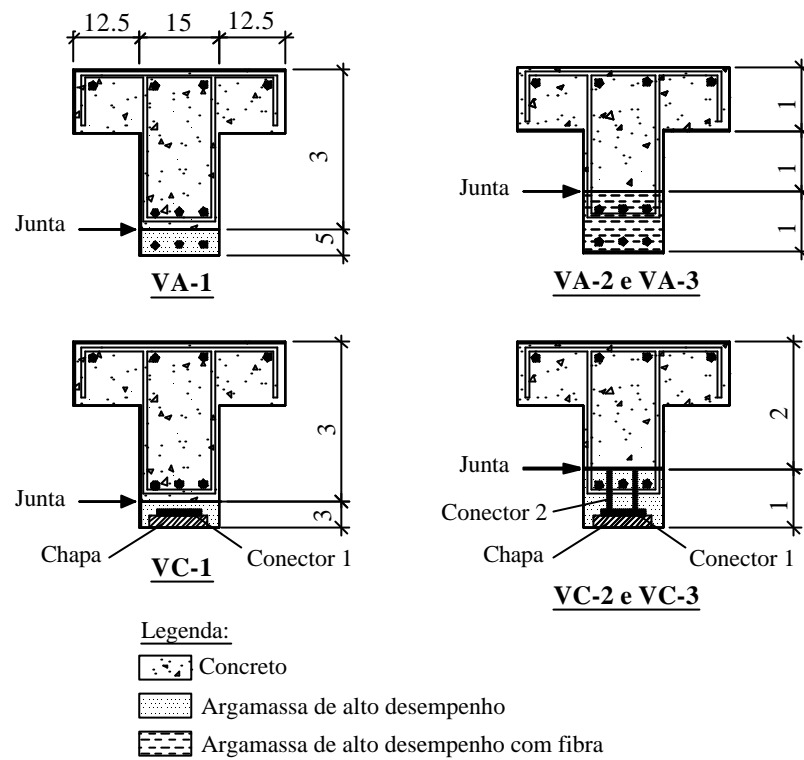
Seções transversais das vigas ensaiadas por REIS (1998)
